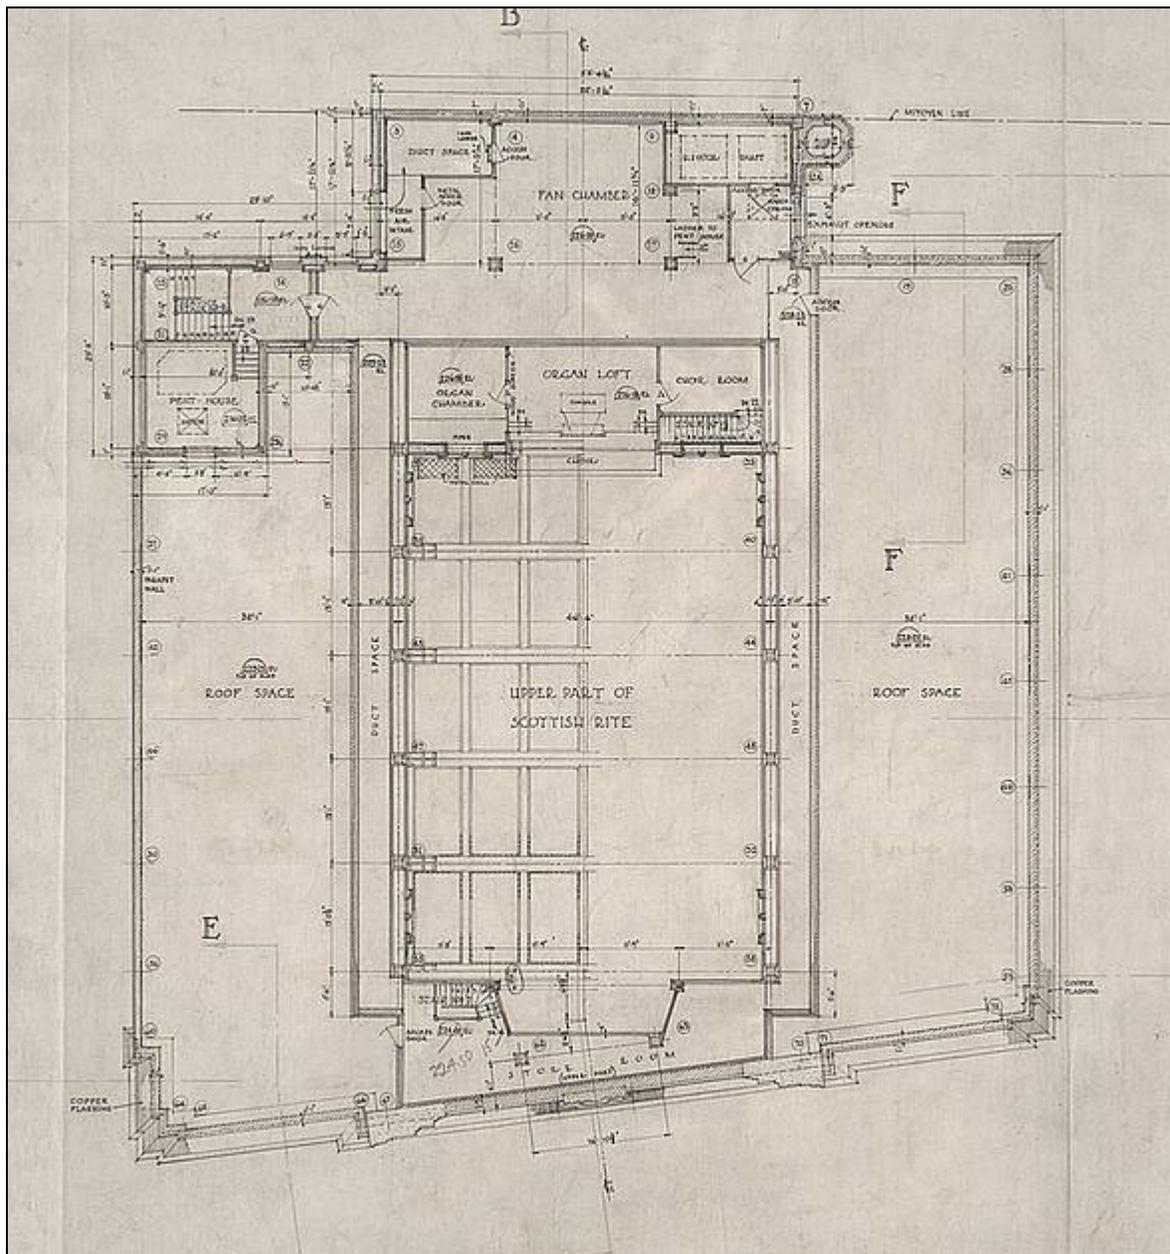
Plan du *second floor mezzanine*, étage n° 8 (détail de la feuille du plan). Plans de John S. Archibald, Université McGill, collection CAC.
